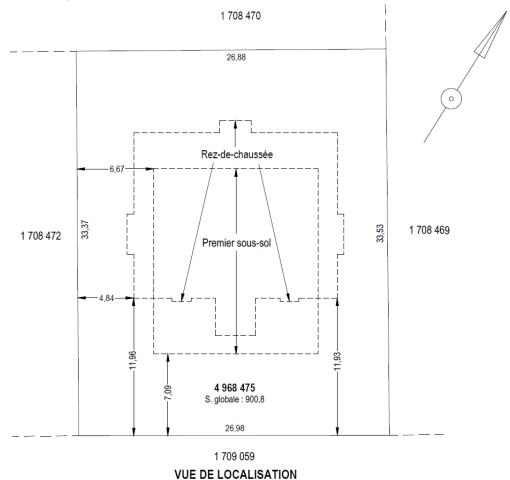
Vue de localisation — Périmètres multiples d'un bâtiment
